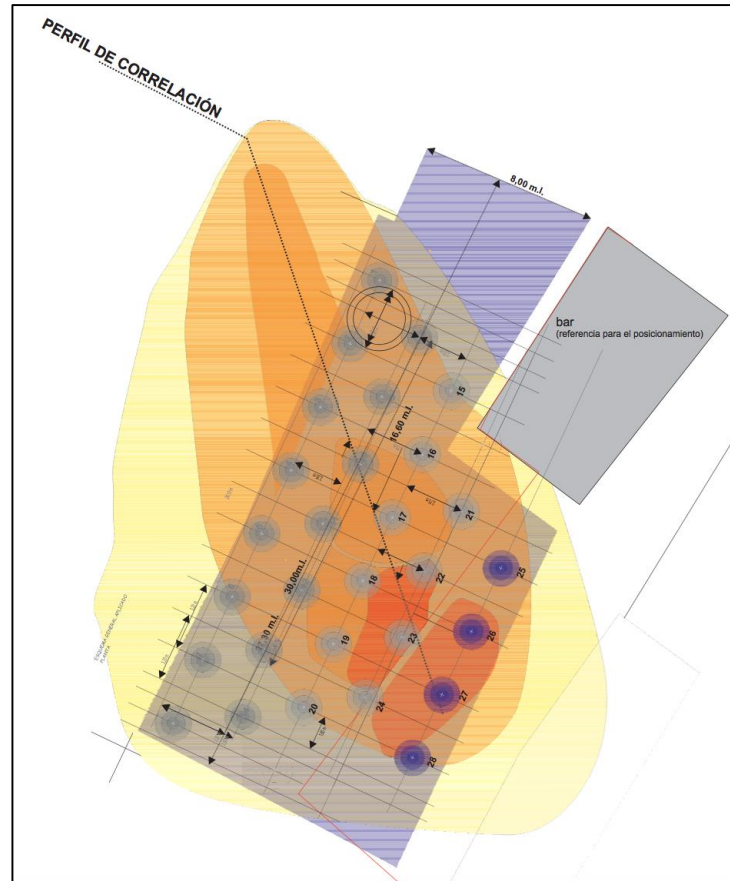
Recorte del plano de situación acotado para el tratamiento propuesto con columnas de mortero y geomalla. Hoja 7 de 10. Fuente: CTA, S. A.
